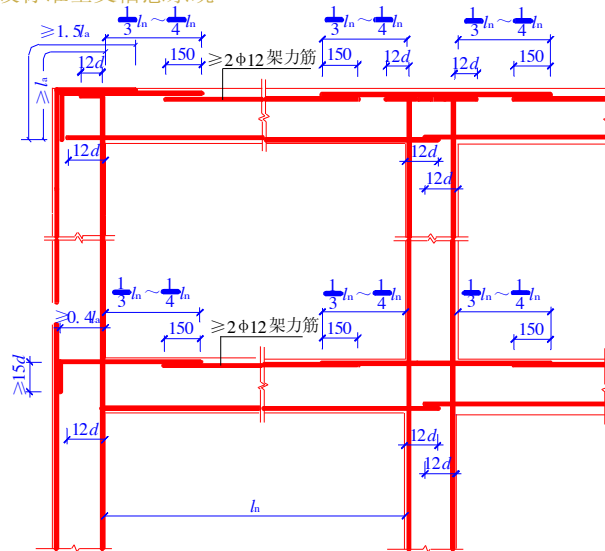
非抗震设计时框架梁、柱纵向钢筋在节点区的锚固要求
